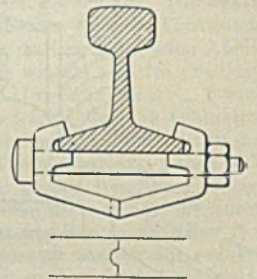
bis 69. Amerikanische Schraubenklemmen.
